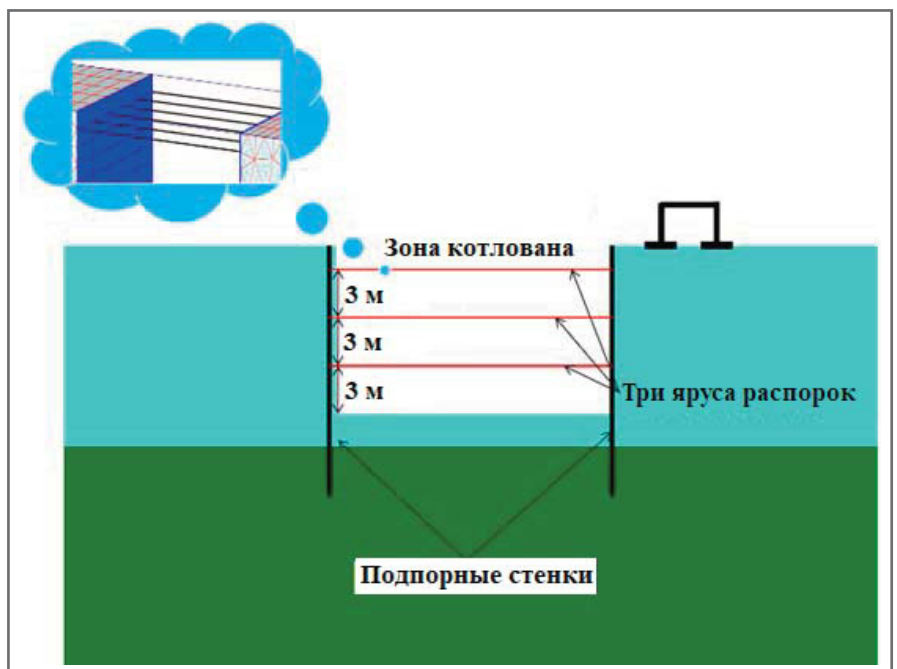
Схематический вертикальный разрез котлована с системой горизонтальных распорок для поддержки подпорных стенок [7]
